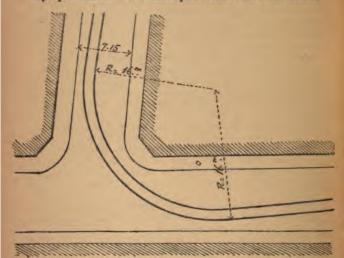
Tracé d'une voie de tramway au croisement de deux chaussées.
